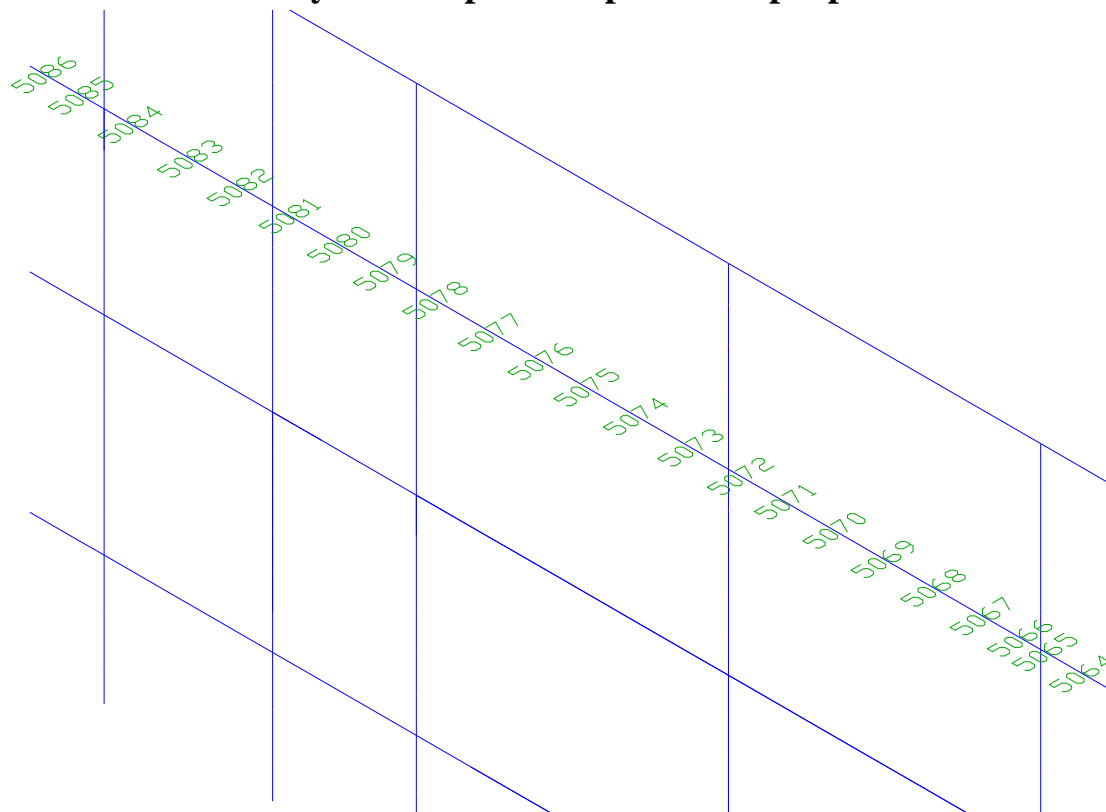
Обозначение элементов ригеля перекрытия по оси 8
